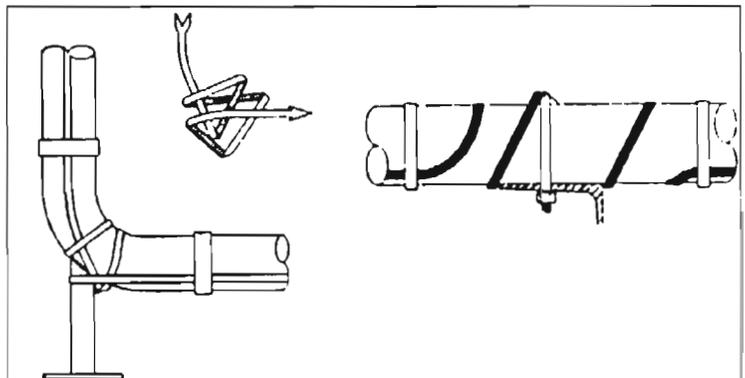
Colocación sobre soporte tipo columna y soporte tipo mensula.
